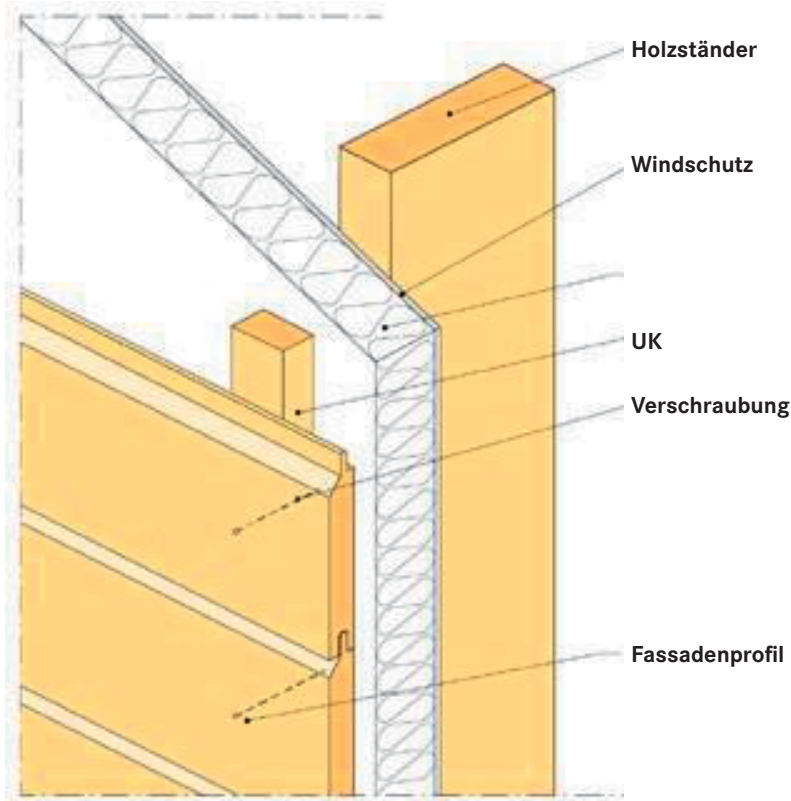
Horizontale Fassadenprofile sollten mit einem Abstand von 30 mm zur Oberkante des Profils verschraubt werden.
